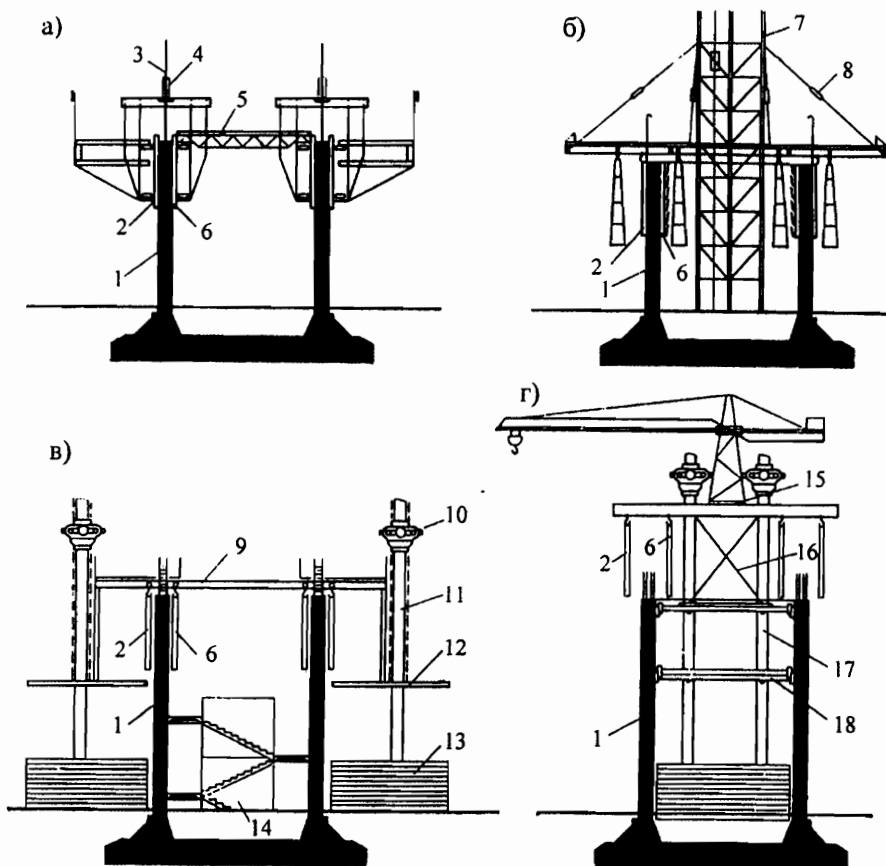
Способы возведения монолитных железобетонных стволов ядер жесткости: а - в скользящей опалубке; б - в переставной опалубке; в - с плиты кровли с помощью домкратного устройства; г - с помощью агрегатного устройства; 1 - ствол ядра жесткости; 2 и 6 - наружные и внутренние щиты опалубки; 3 - опорные арматурные стержни; 4 - специальные домкраты; 5 - рабочие площадки; 6 - опорные стальные трубчатые леса; 8 - ручные тали или рычажные лебедки; 9 - устройство для возведения ствола с плиты кровли; 10 - подъемник; 11 - колонна; 12 - плита кровли в процессе подъема; 13 - пакет плит перекрытий; 14 - элементы лестниц и лифтов внутри ствола; 15 - металлическая платформа с башенным краном; 16 - связи; 17 - внутривольные колонны; 18 - внутривольные плиты перекрытий
